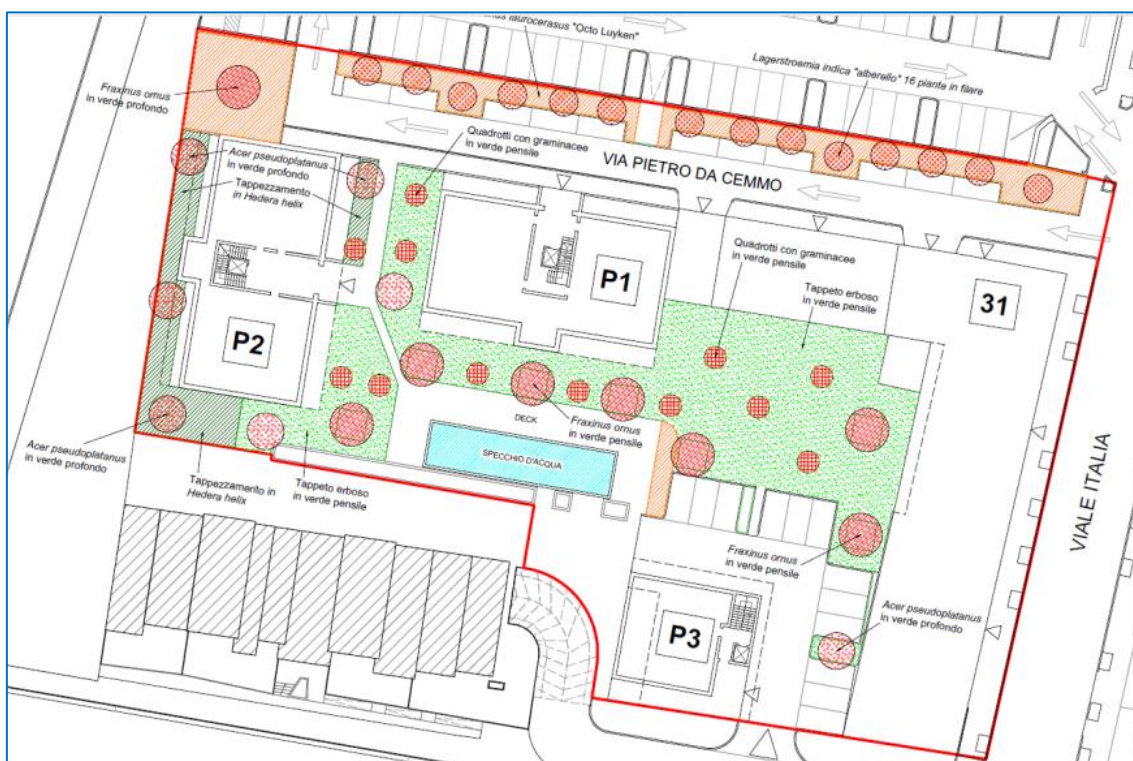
Miniatura estratta dalla tavola di progetto del verde
